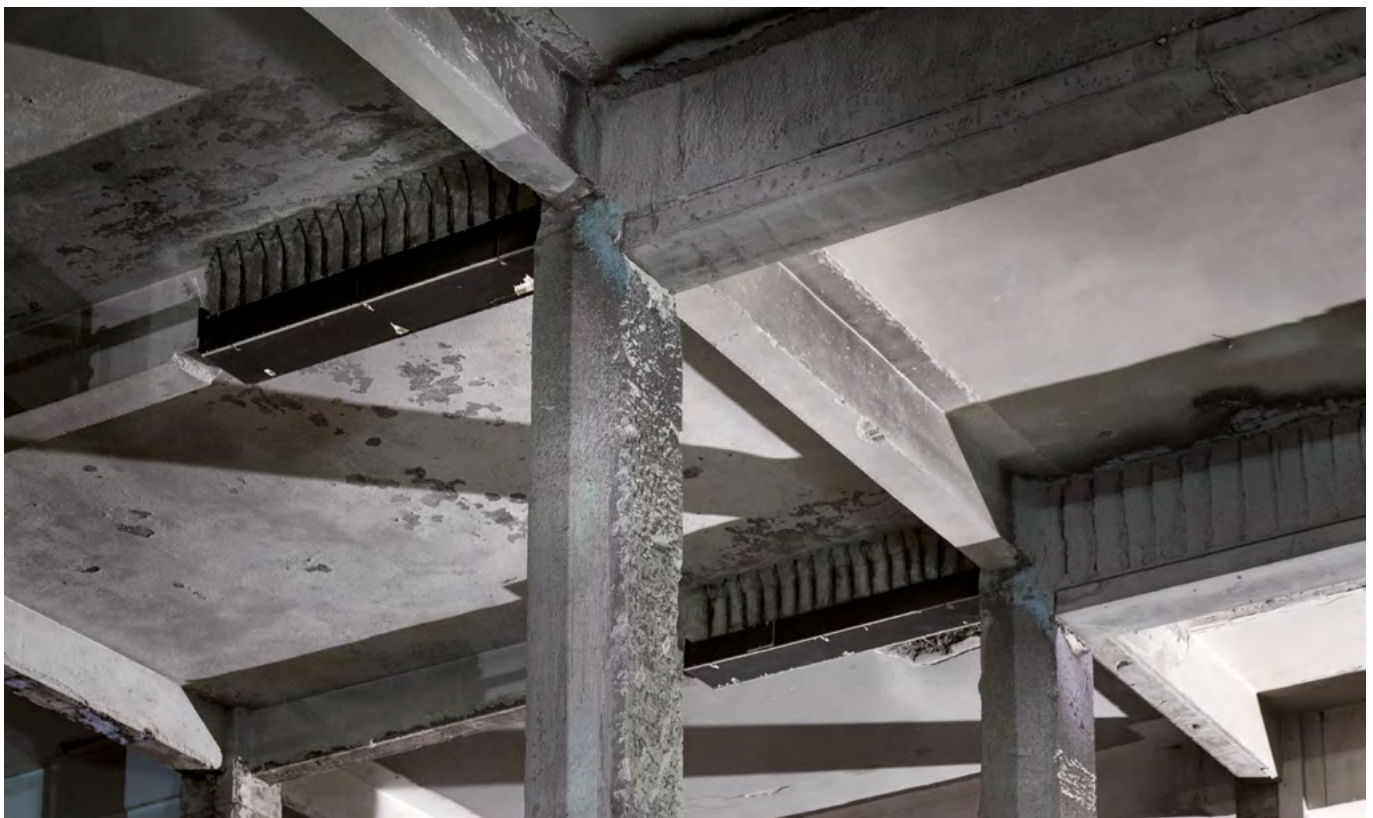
Refuerzo general a cortante de las vigas de planta baja. (foto: Paco Gómez).
